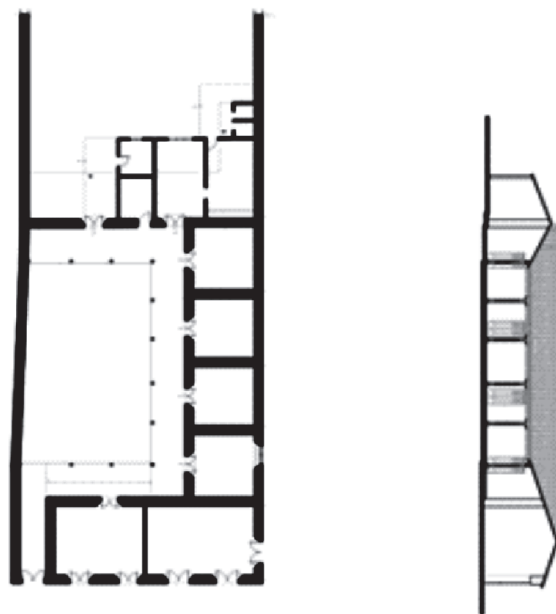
Planta y Sección del Patio Semi- Claustrado.
